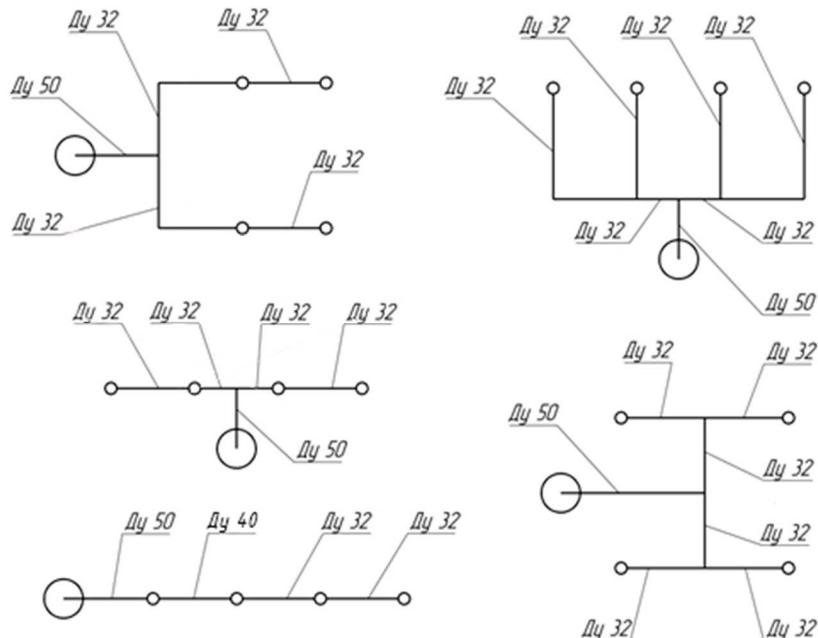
Рекомендуемые схемы проектирования трубопровода в составе МУПТВ-160-Г-ВД с насадками-распылителями «HC-390-C».
